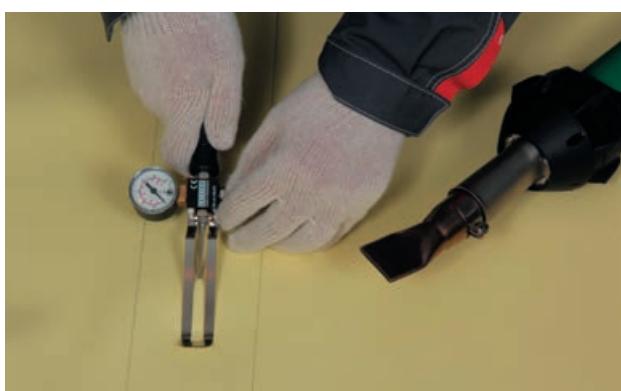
Контроль качества сварного шва с помощью манометра
